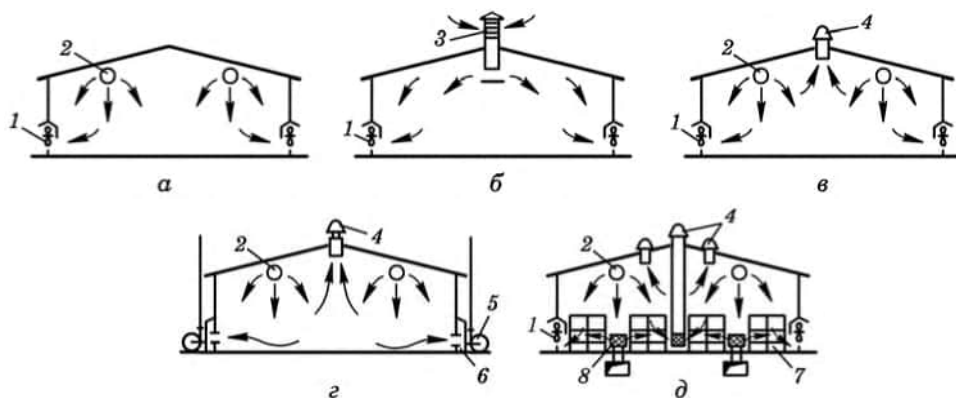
Схемы вентиляции в птицеводческих помещениях:
